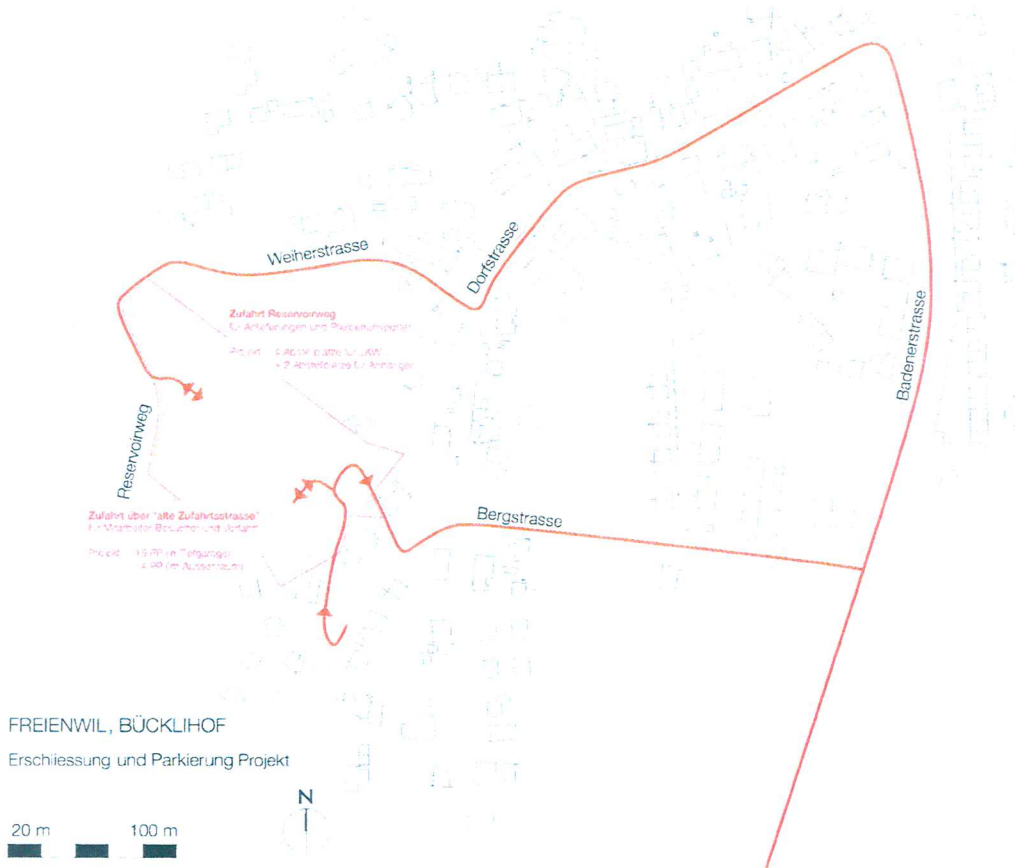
Erschliessung und Parkierung Projekt Pferdezentrum Bücklihof
